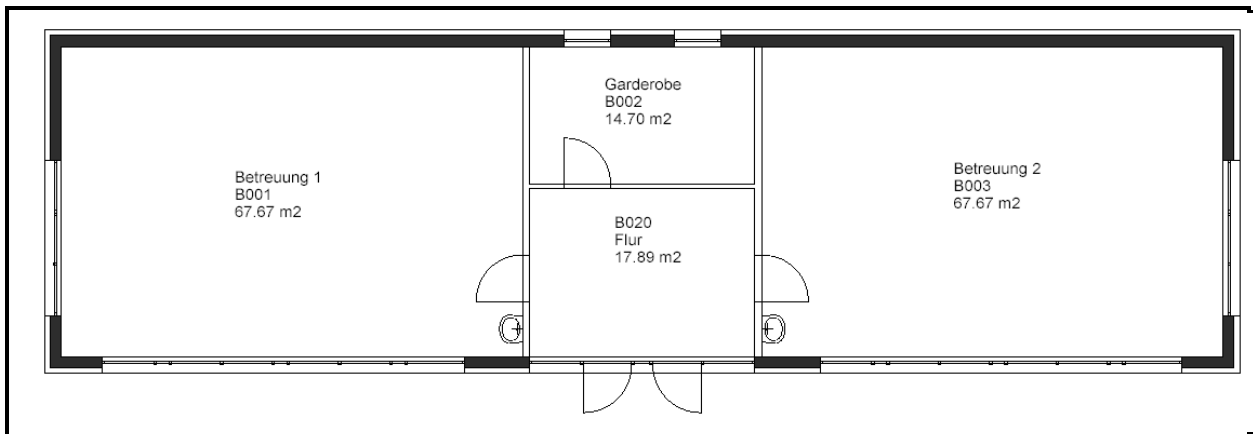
Brüder-Grimm Schule: Grundriss Pavillon
